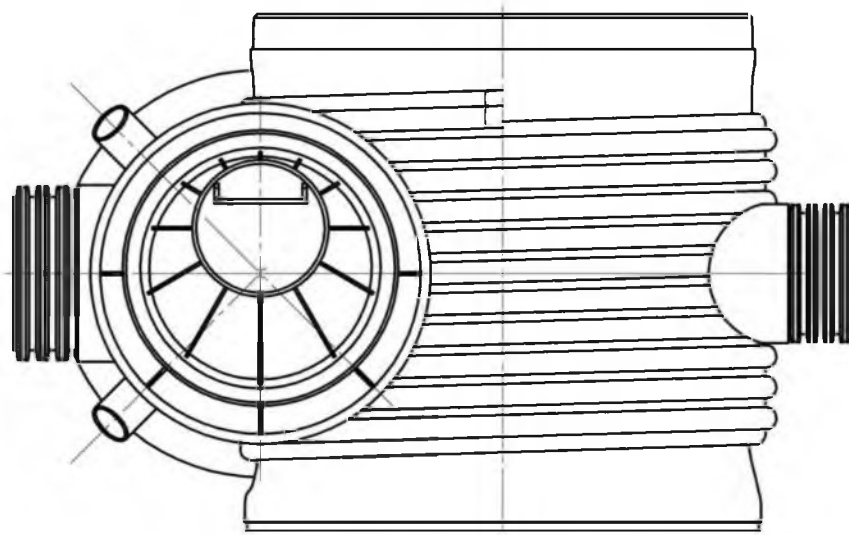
Тангенциальный сварной колодец с тройником
